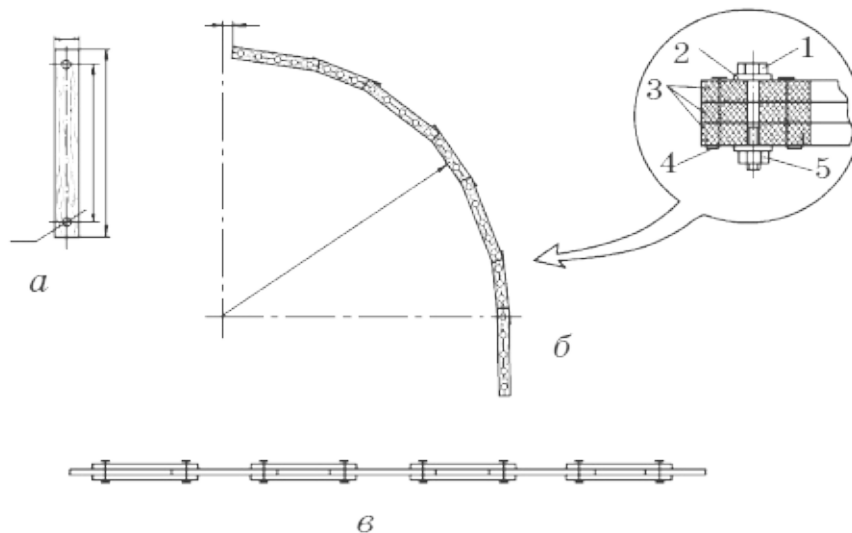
Конструкция дуги: а — планка; б — дуга в рабочем состоянии; в — дуга до изгиба ее по шаблону: 1 — болт М6 × 60; 2 — шайба; 3 — планки; 4 — гвоздь 3 × 70; 5 — гайка М6
